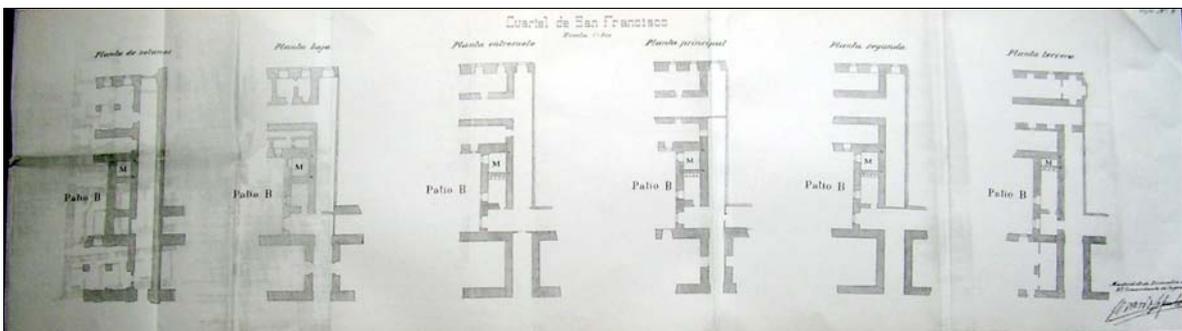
Cuartel de San Francisco. Levantamiento planimétrico de los distintos niveles destinados a retretes del cuartel: sótanos y plantas baja, entresuelo, principal, segunda y tercera. Escala original, 1:200. Archivo General Militar, Sección 3ª., división 3ª., leg. 580.
